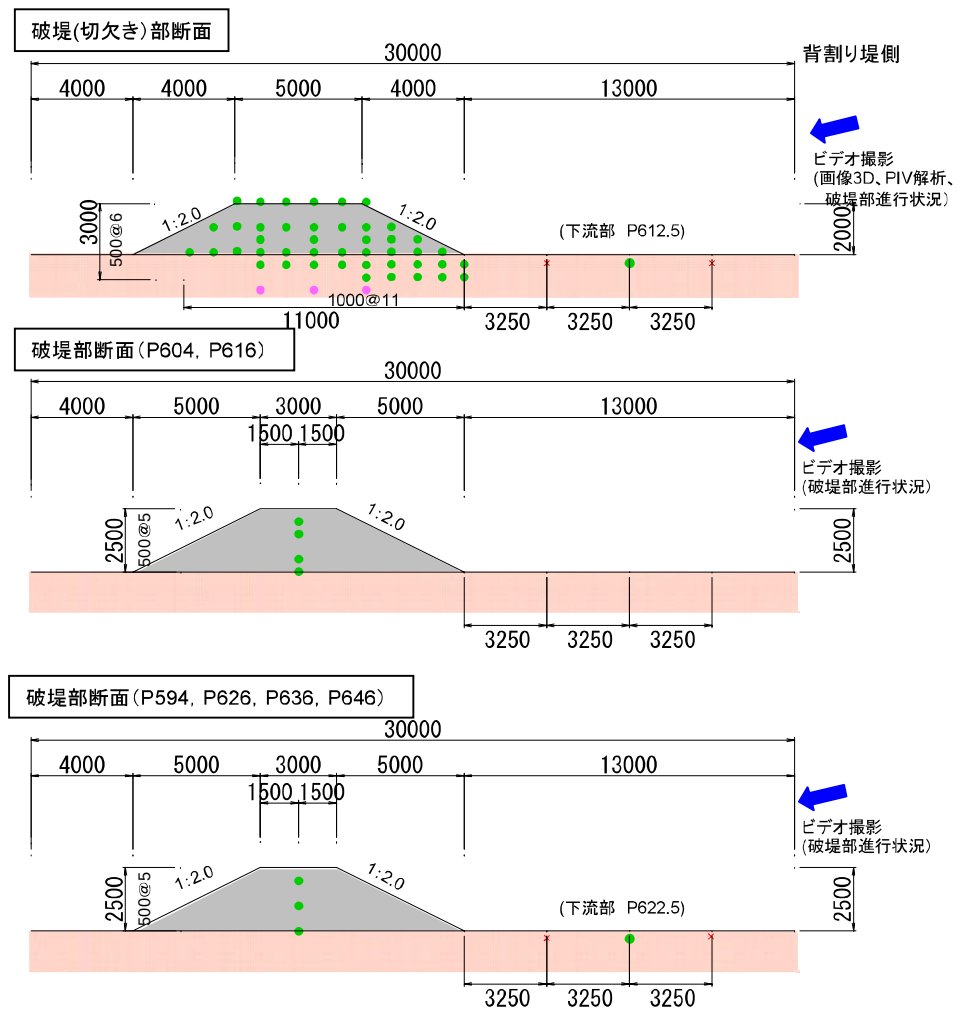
(2) 実験②③(破堤実験)の計測地点配置図
